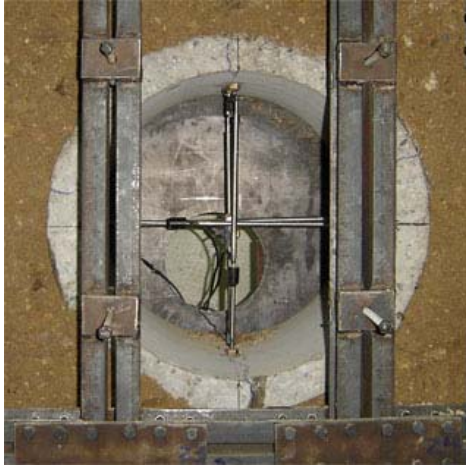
Estado de la tubería al finalizar el ensayo (en azul están marcados los lugares de aparición de grietas)
